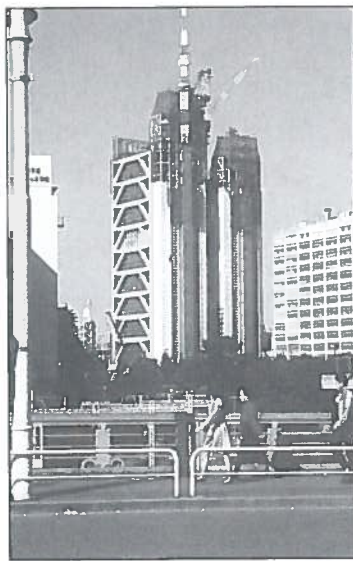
Edificio con controventi eccentrici in facciata (Tokyo)
